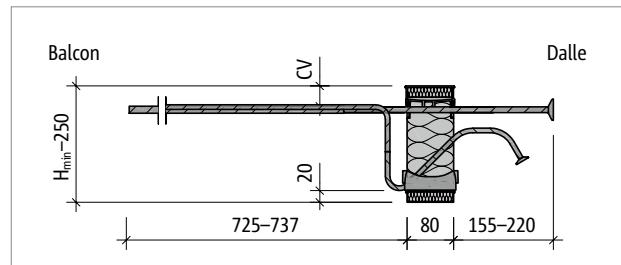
Schöck Isokorb® T type K-U-M2 : coupe du produit
